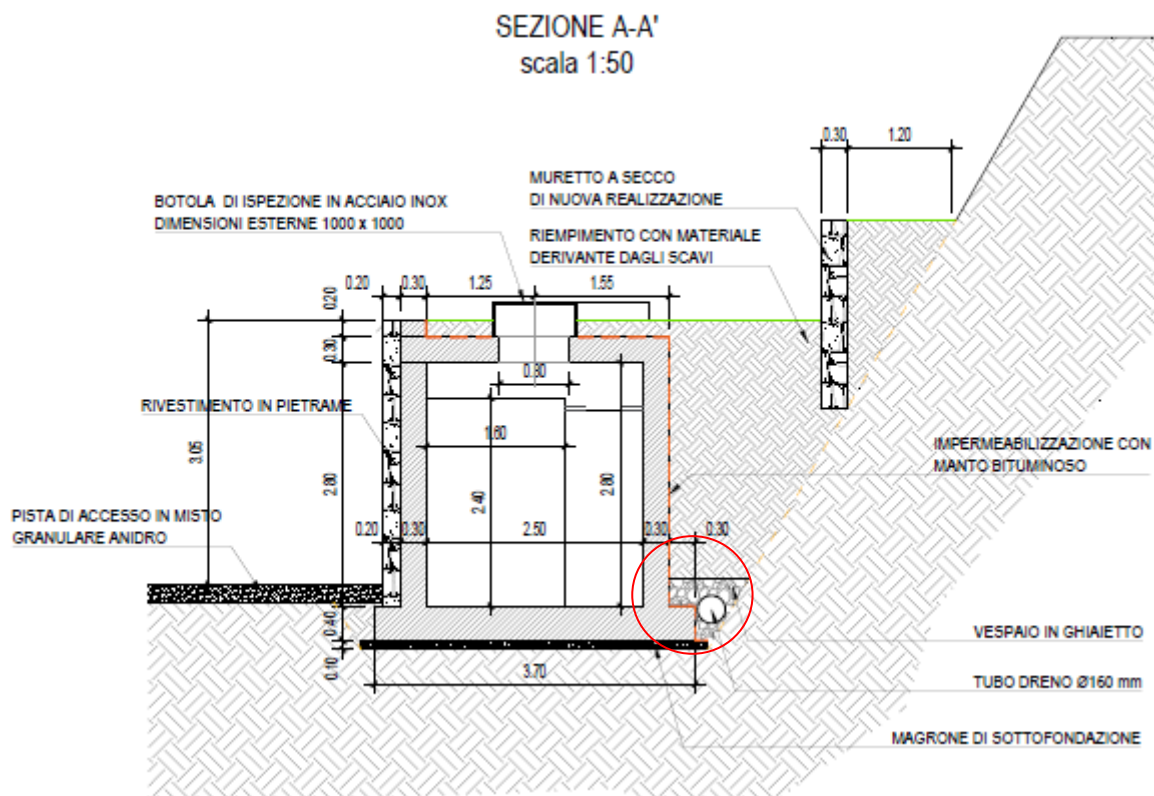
Dettaglio delle misure di impermeabilizzazione e drenaggio della cabina elettrica in progetto
